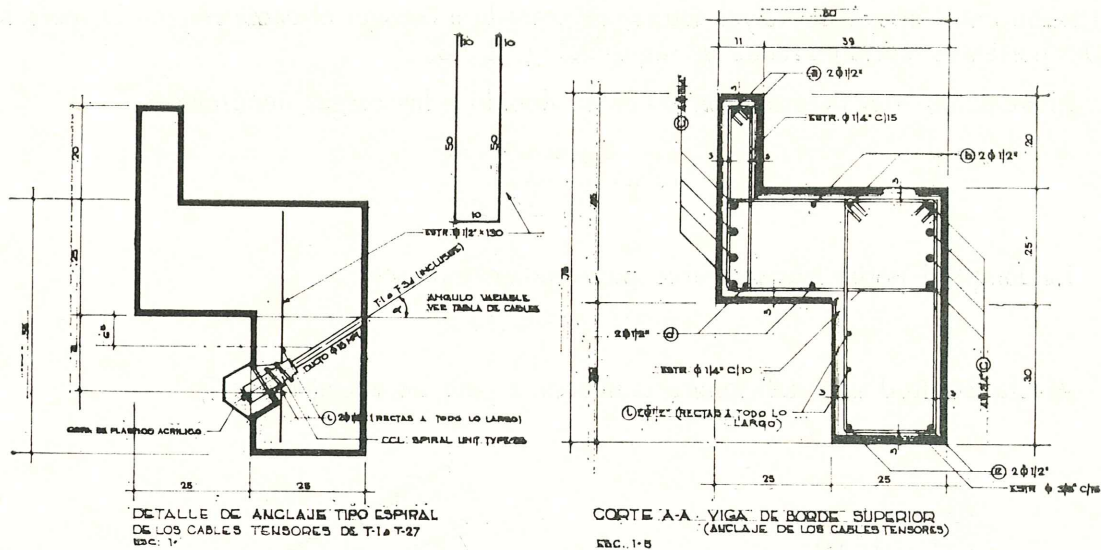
Detalle de anclaje de los cables tensores en la viga de borde superior.
